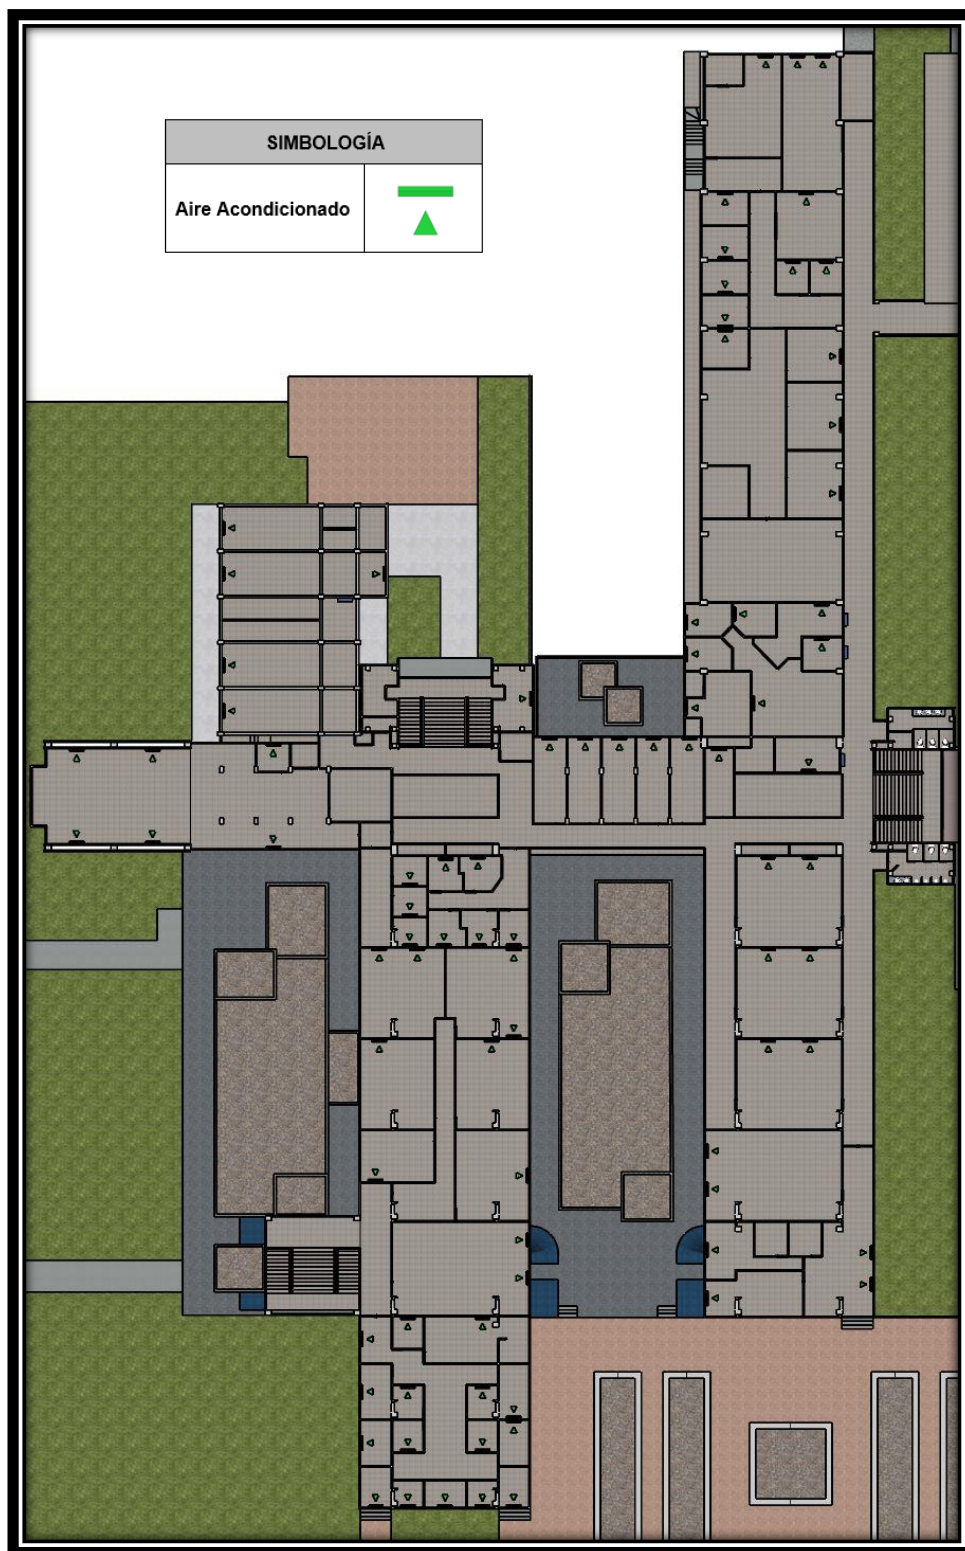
Aires Acondicionados - Planta Baja. Elaboración Propia
